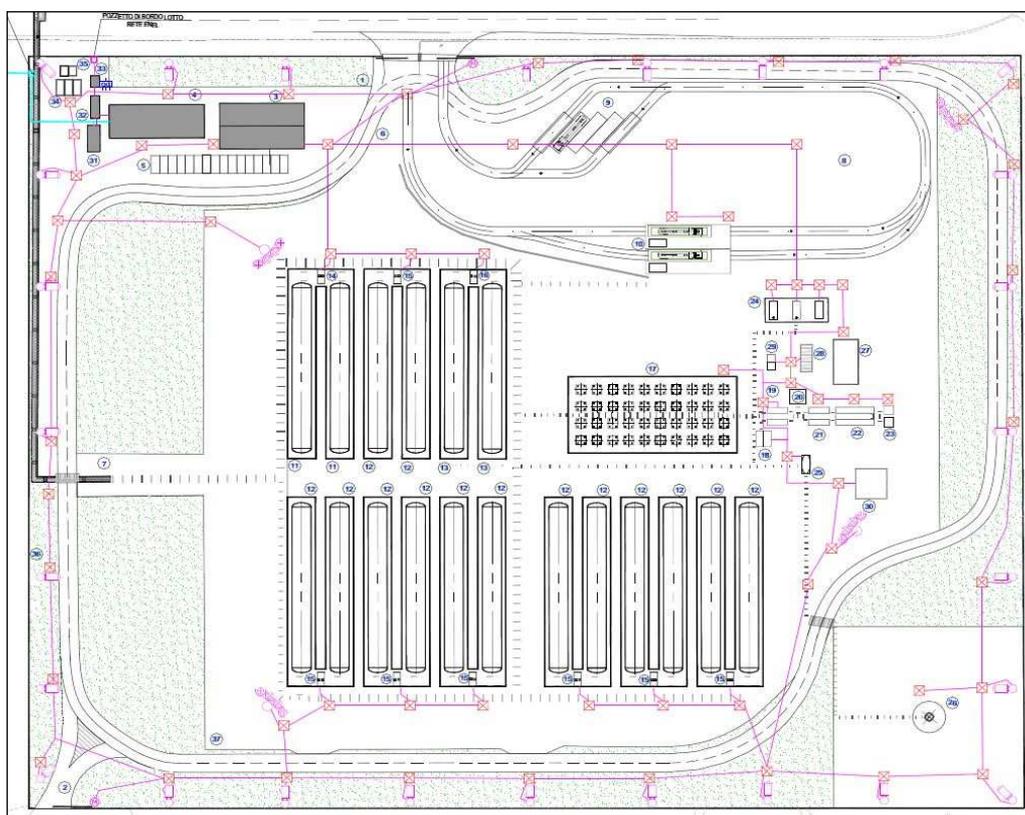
Impianto elettrico e di illuminazione area stoccaggio
